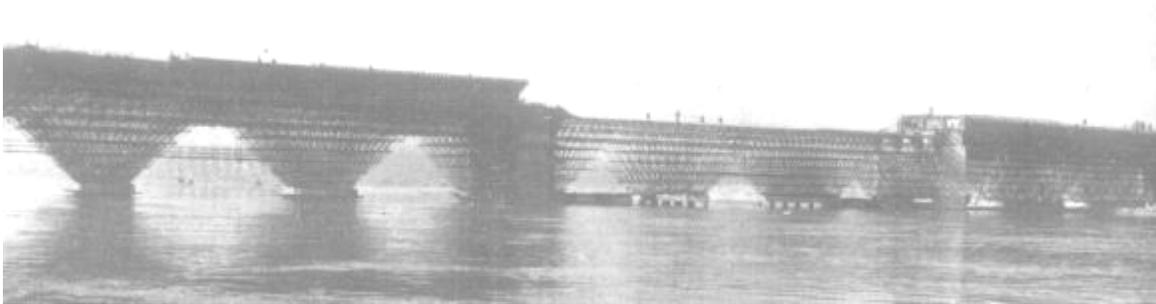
Andamiaje para la construcción del puente sobre el Po en Italia.
